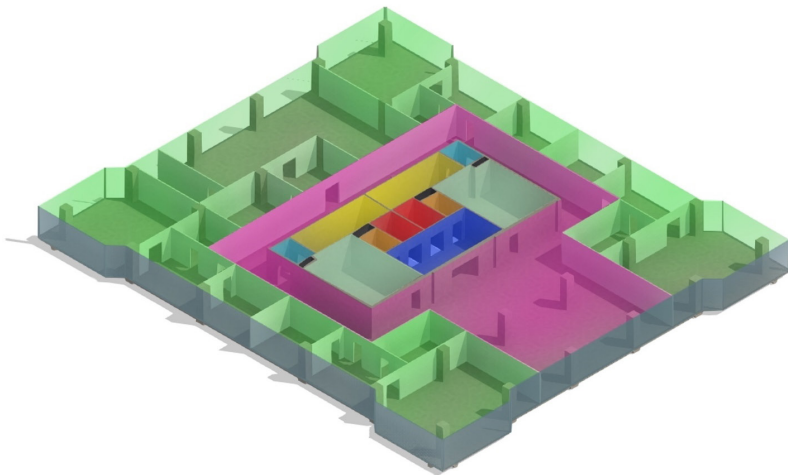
План типового этажа с размещением лестнично-лифтового узла
